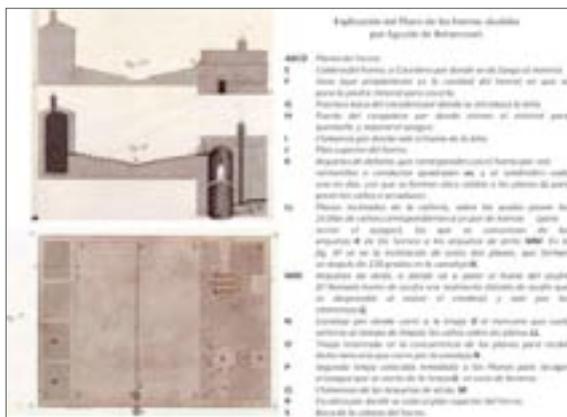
Planta y alzados de un par de hornos aludeles. (Fuente: BETANCOURT, A., 1783)
